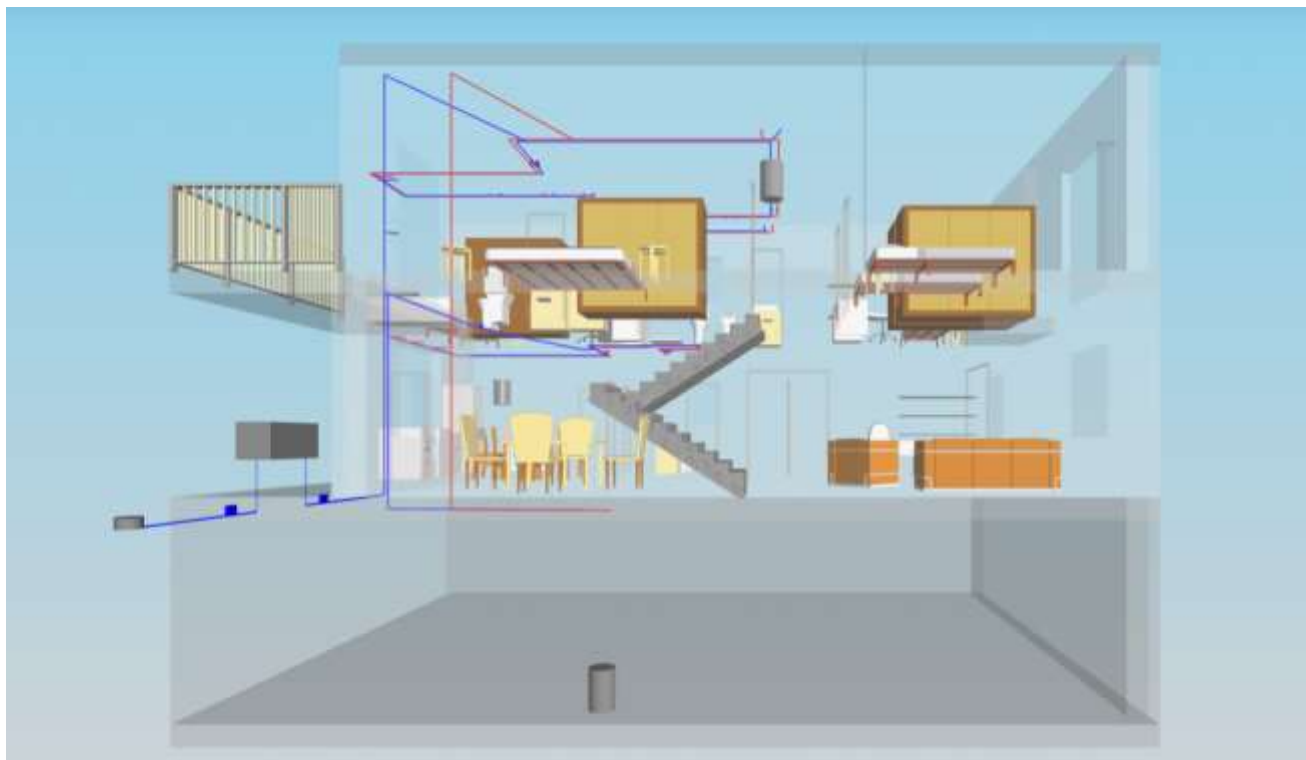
Instalación de fontanería con CYPEPLUMBING Water Systems (Frontal)
